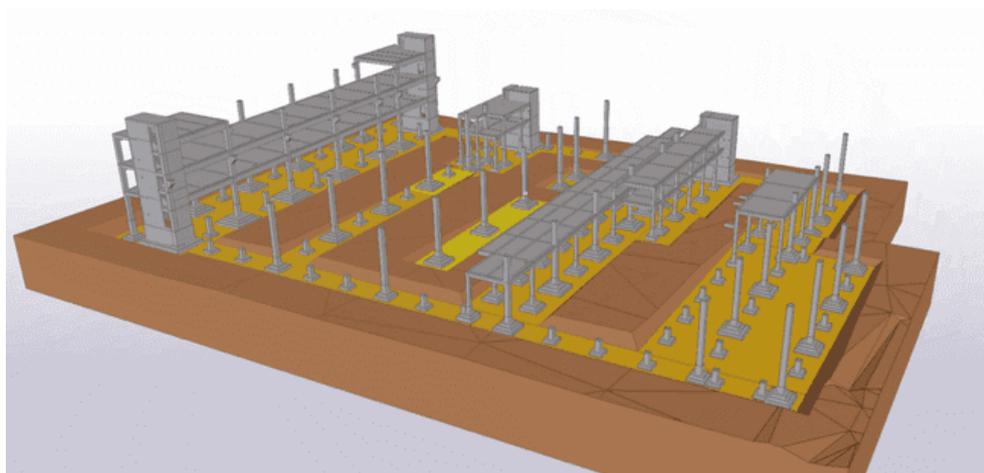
Вид модели монолитных железобетонных элементов каркаса здания с посадкой на модель котлована
